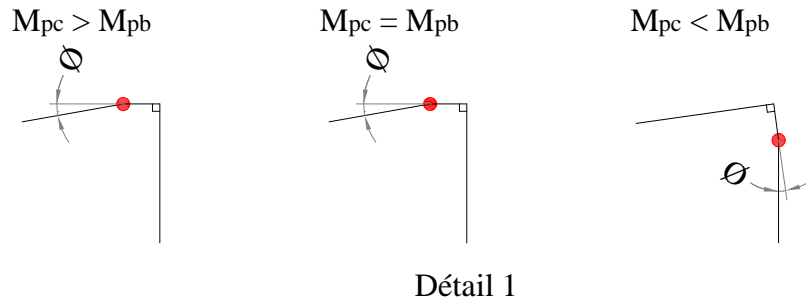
Détail 1 (Rotule plastique dans les jonctions poteaux-poutres)
